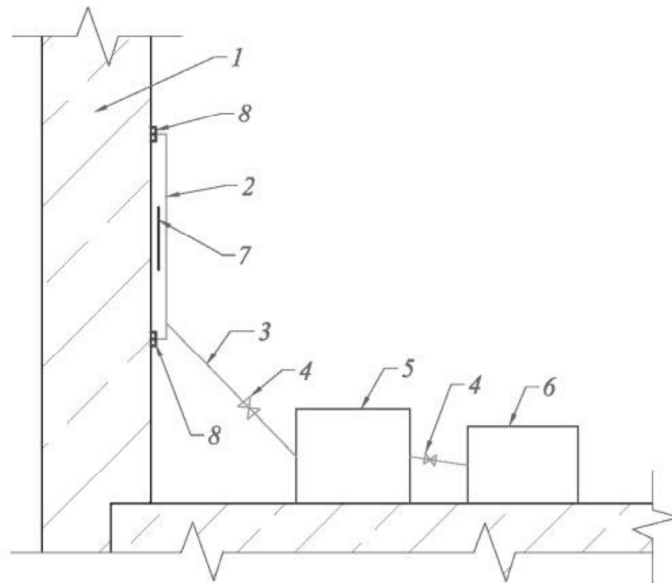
Установа для поверхневого просочення залізобетонних конструкцій. 1 - залізобетонна конструкція; 2 – просочувальна камера; 3 – гумово-металеві трубопроводи; 4 – вентиль; 5 – герметична ємність; 6 – балон з інертним газом; 7 – генератор ультразвукових коливань; 8 – кріплення
